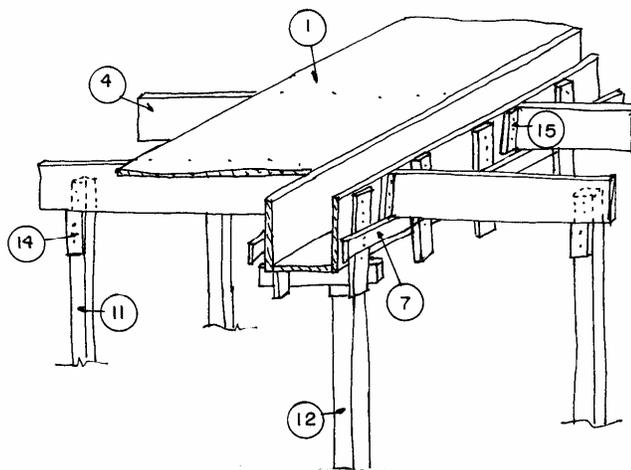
Detalhe da Fôrma das vigas sem sarrafo de pressão
